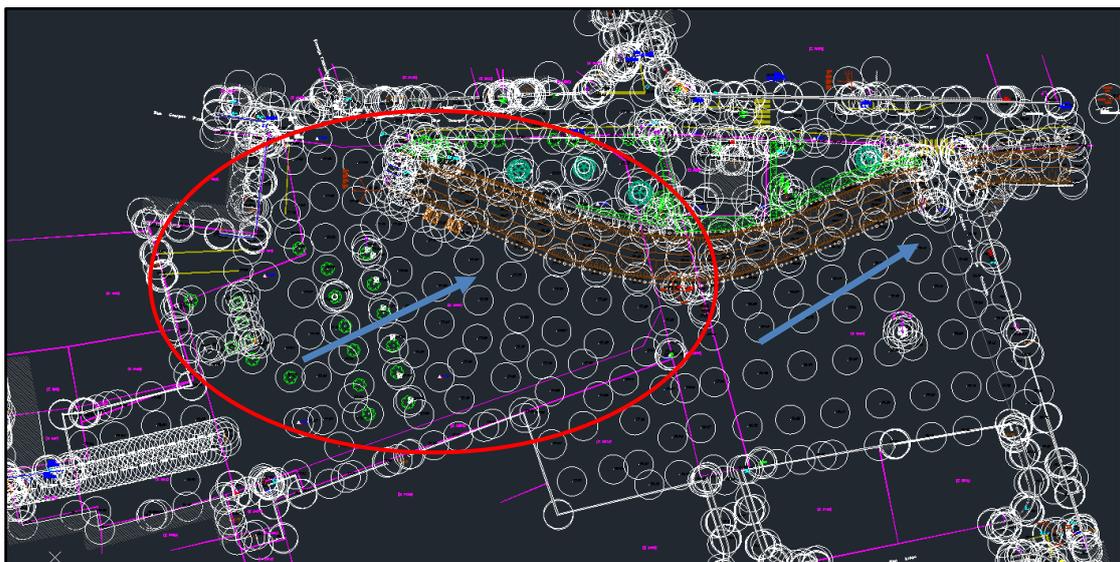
EXTRAIT PLAN TOPOGRAPHIQUE (AUTOCAD)
